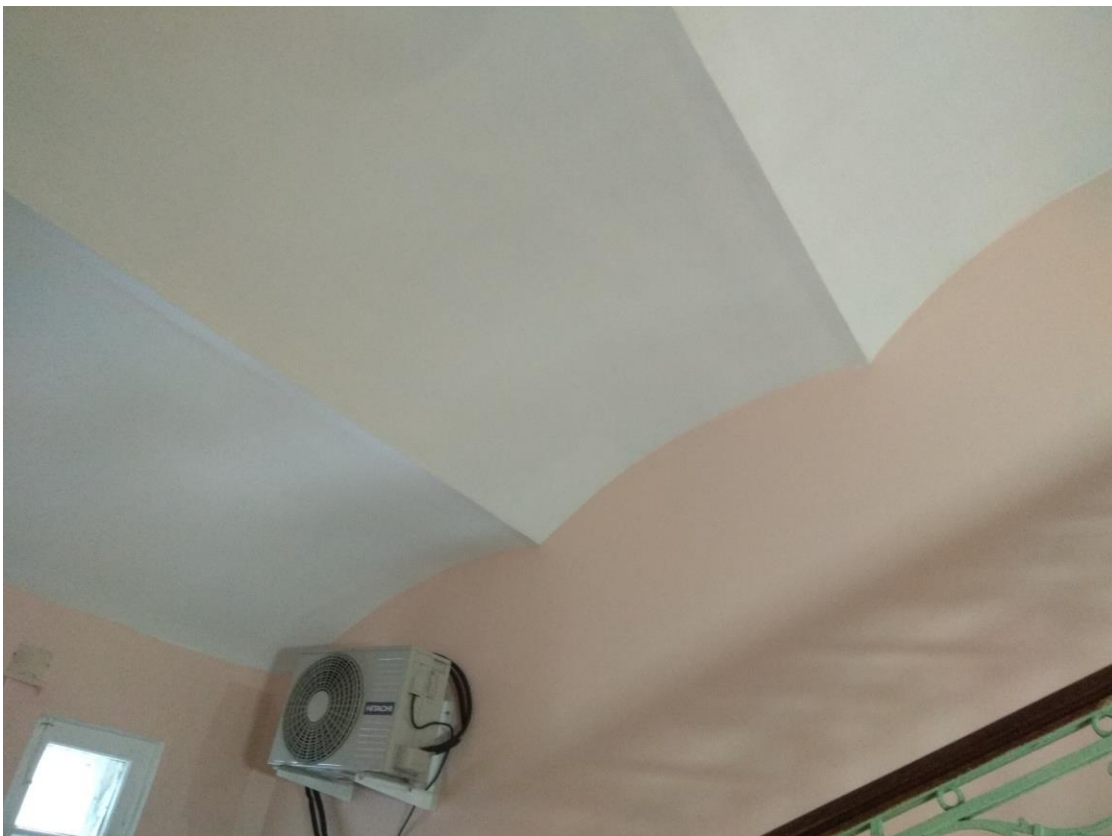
Перекрытие над лестничной клеткой в осях 8-9/Д-И #1
